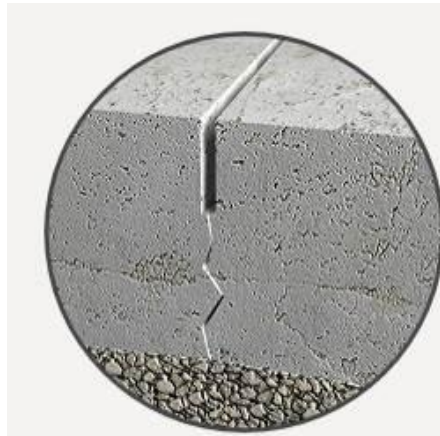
Imatge junta de contracció en paviment de formigó. Font: Norma 6.1 – IC
